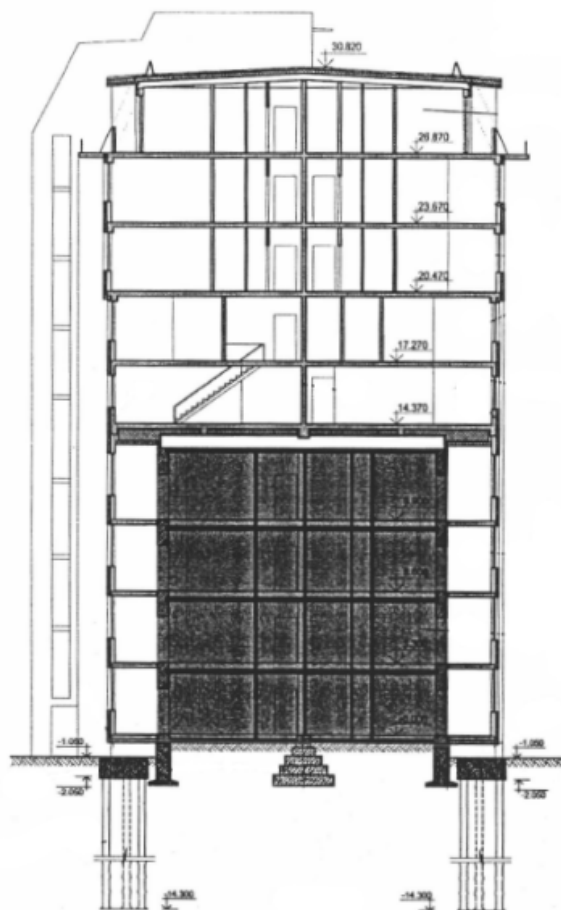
Поперечный разрез реконструируемого здания после реконструкции
